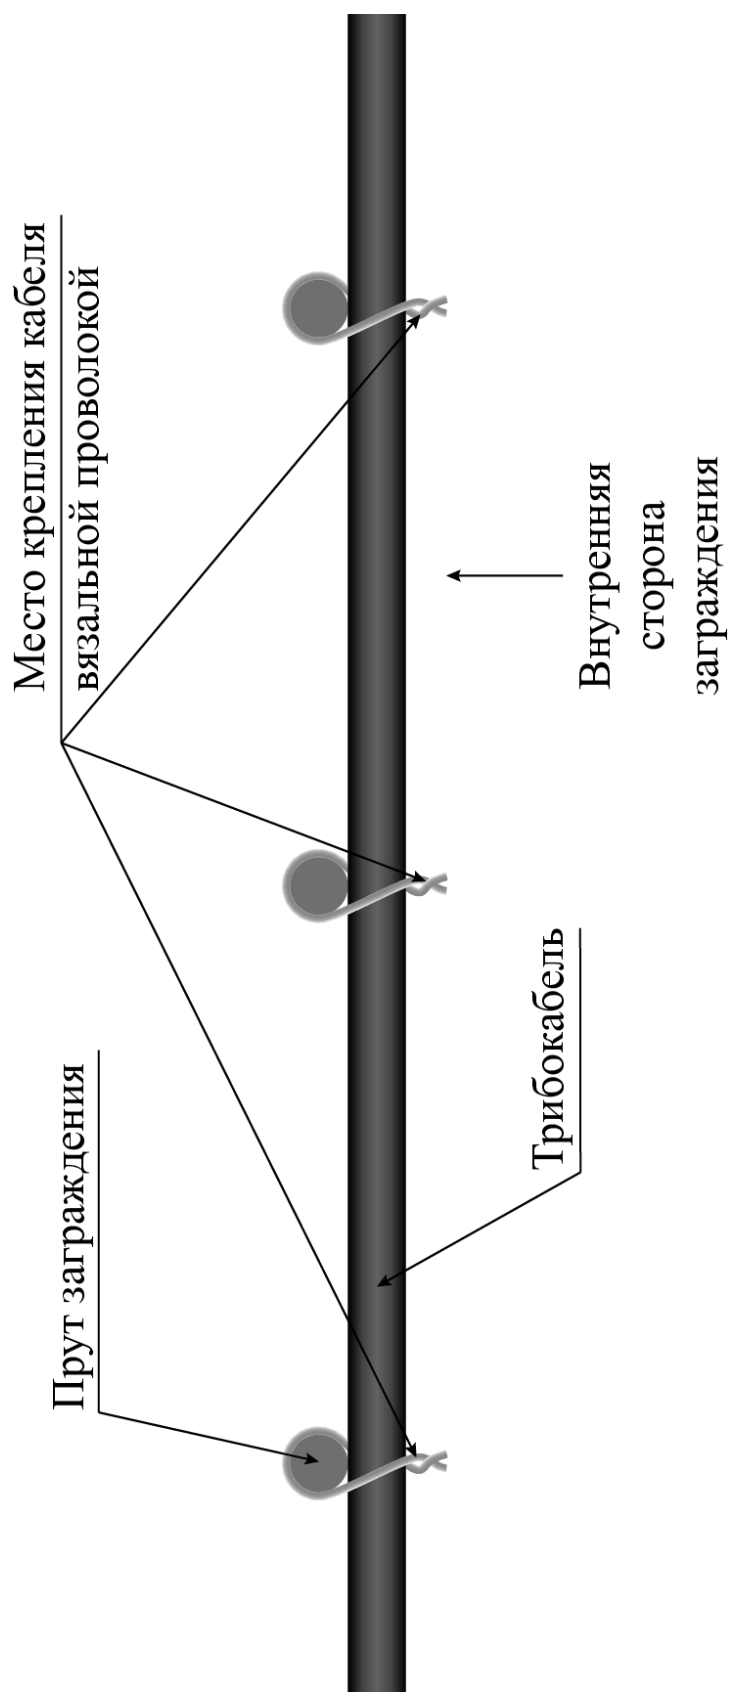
Вариант крепления ЧЭ (трибокабеля) к ограждению из сварных (кованых) решеток
